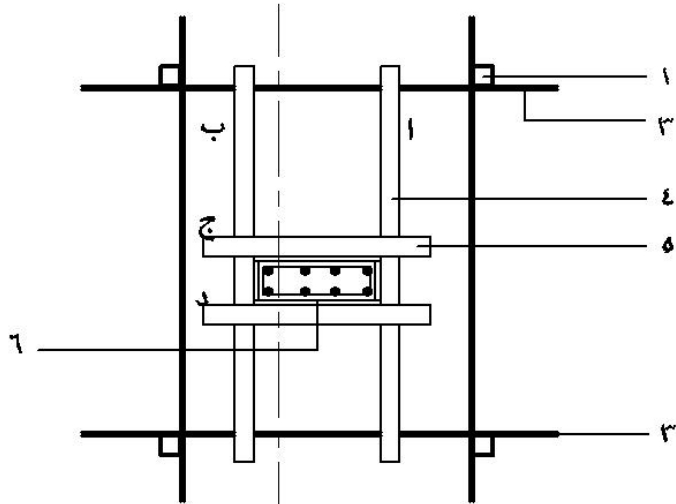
مسقط افقي يبين تحليل العمود
